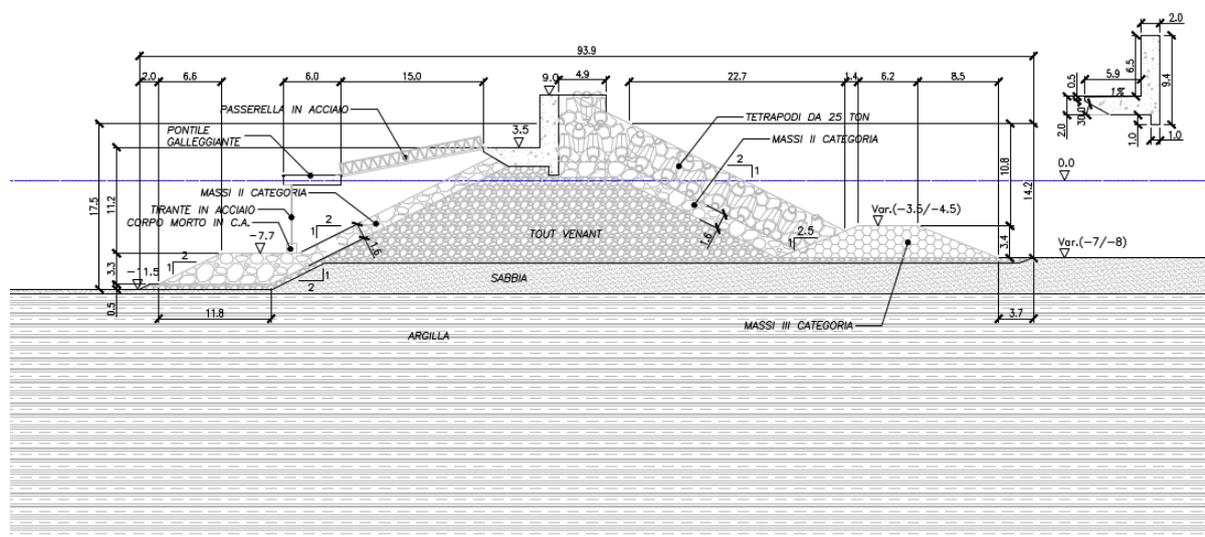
Molo Traiano – Sezione molo traiano sezione non traccimabile con ormeggi (Sez. A1)
